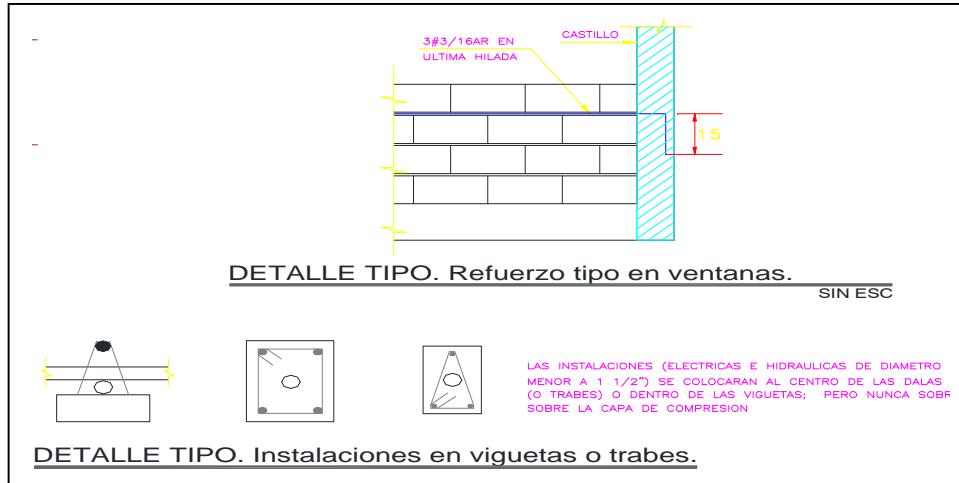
Detalle de Refuerzo Horizontal en muros e Instalaciones en Trabes.
